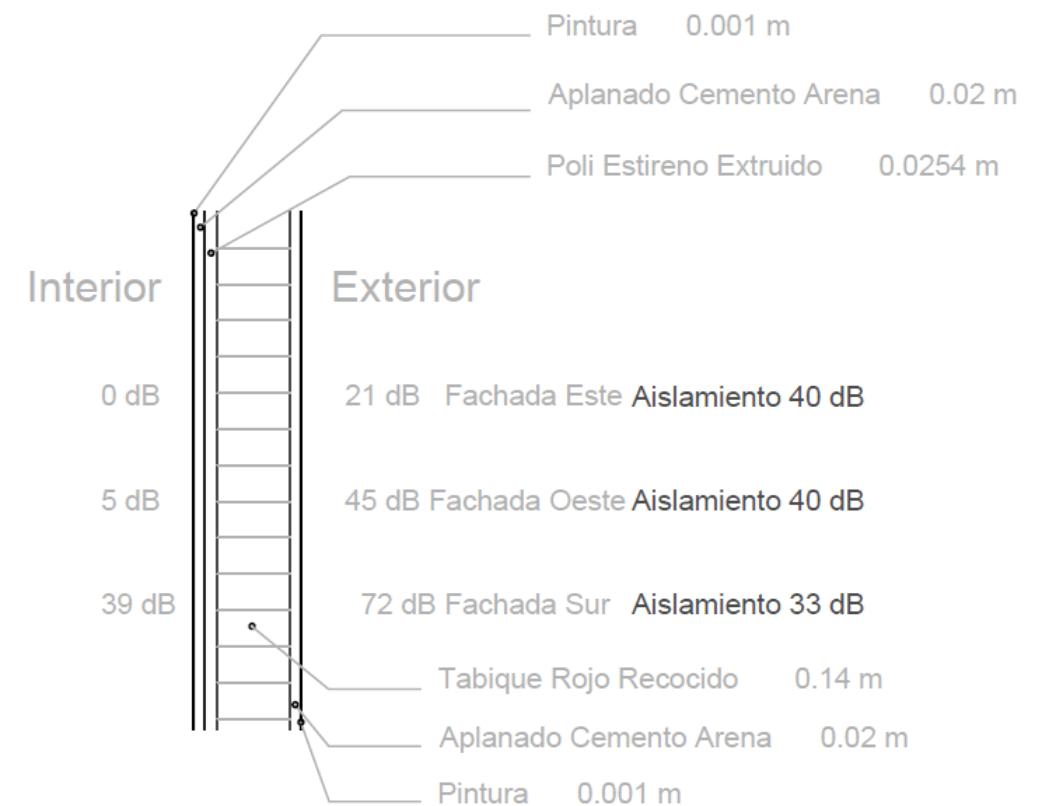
Sistema Constructivo de Muros y Aislamiento Acústico por Fachada
